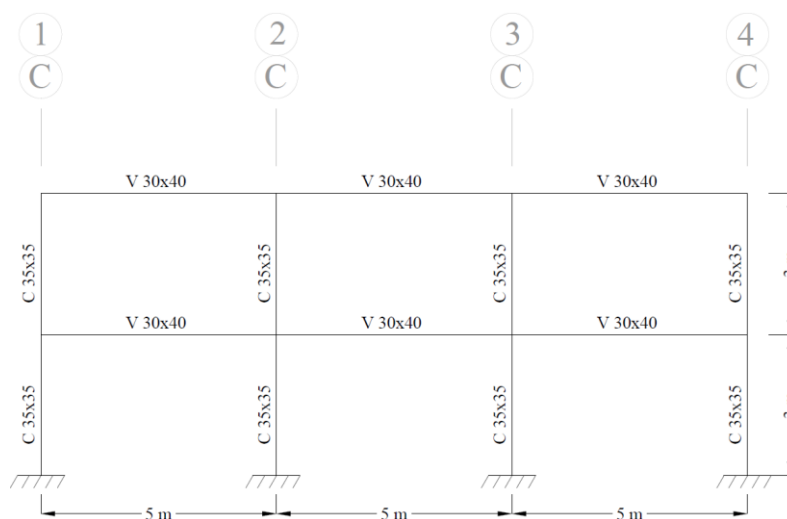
Dimensiones de los elementos estructurales del pórtico 1.
